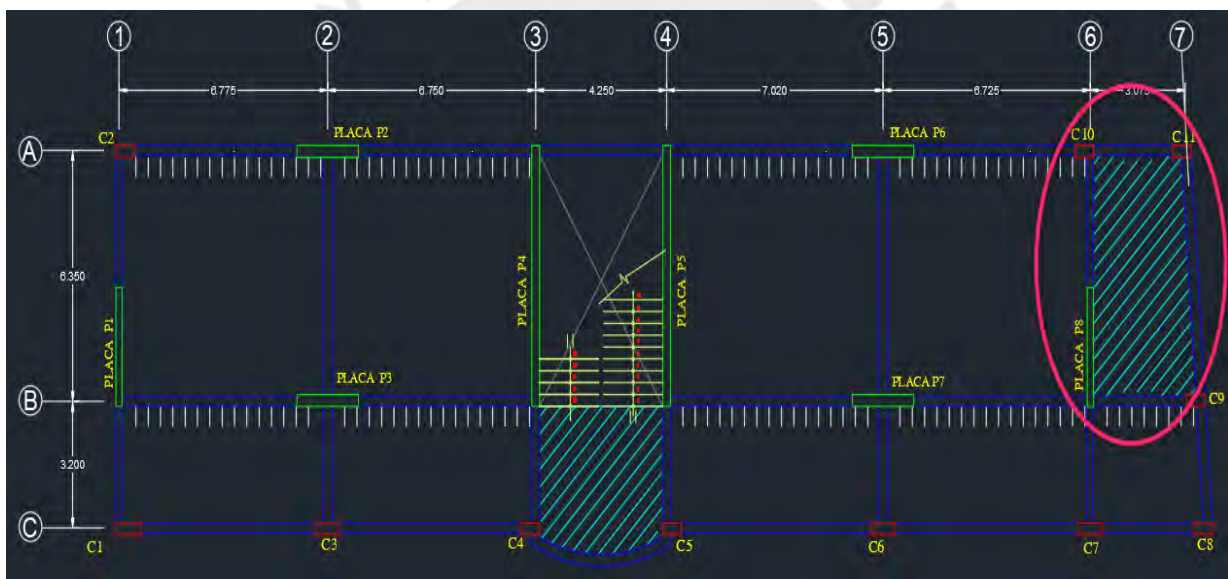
Vista en planta del primer piso (En círculo rojo el ambiente del servicio higiénico), del plano estructural. Fuente: Propia
